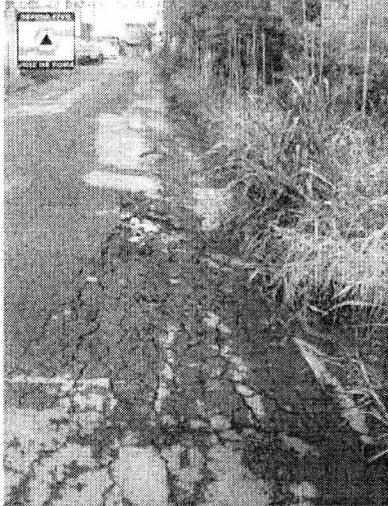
AFUNDAMENTO NO PISO ASFÁLTICO
